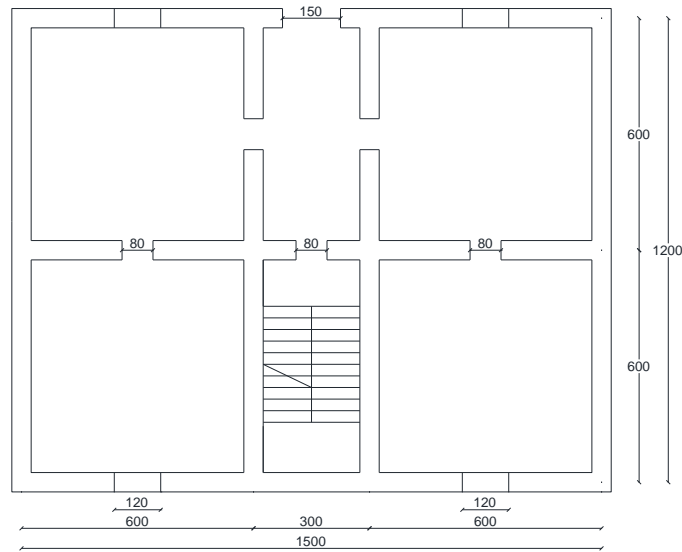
Pianta piano terra dell'Unità Strutturale di base
